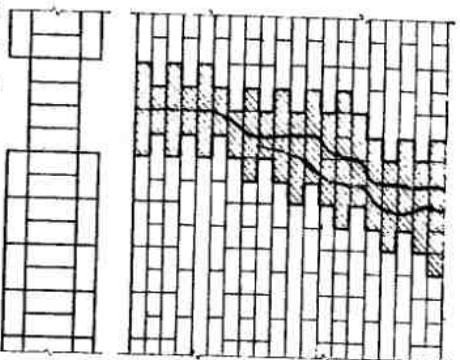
Подготовка трещины с разборкой старой кладки
